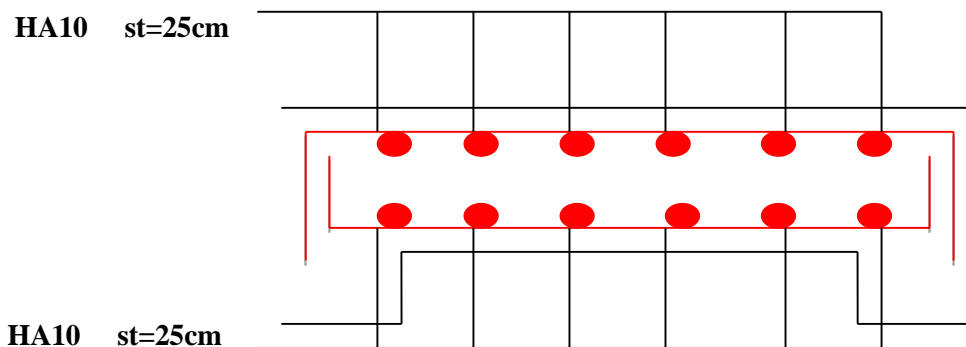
Schéma de ferrailage de la dalle d'ascenseur .
